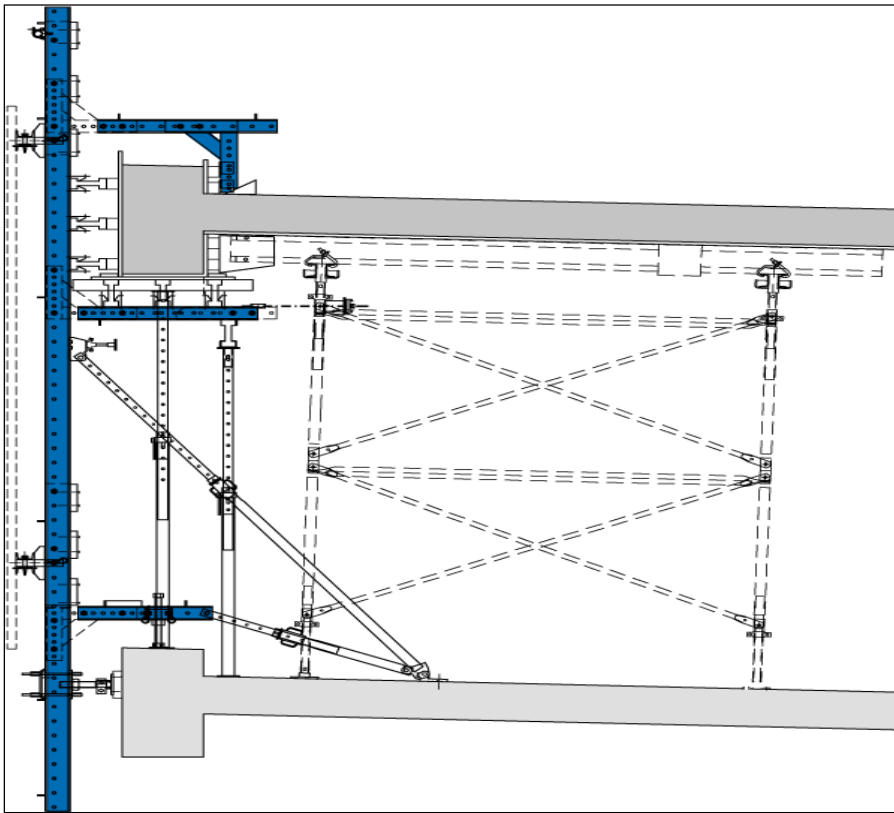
Randunterzüge ohne Gerüst⁴⁹⁷
